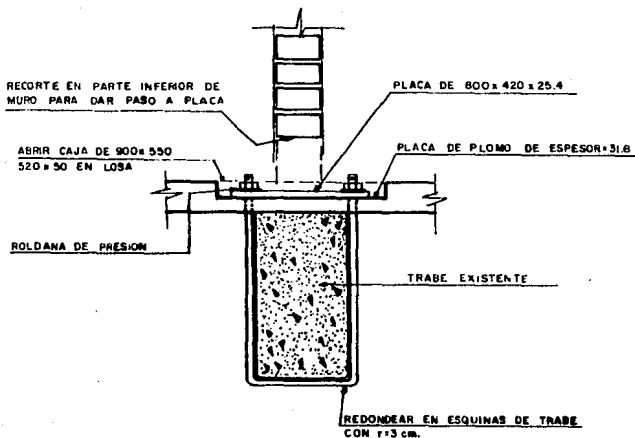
ESTRIBOS ROSCADOS EN VIGAS
